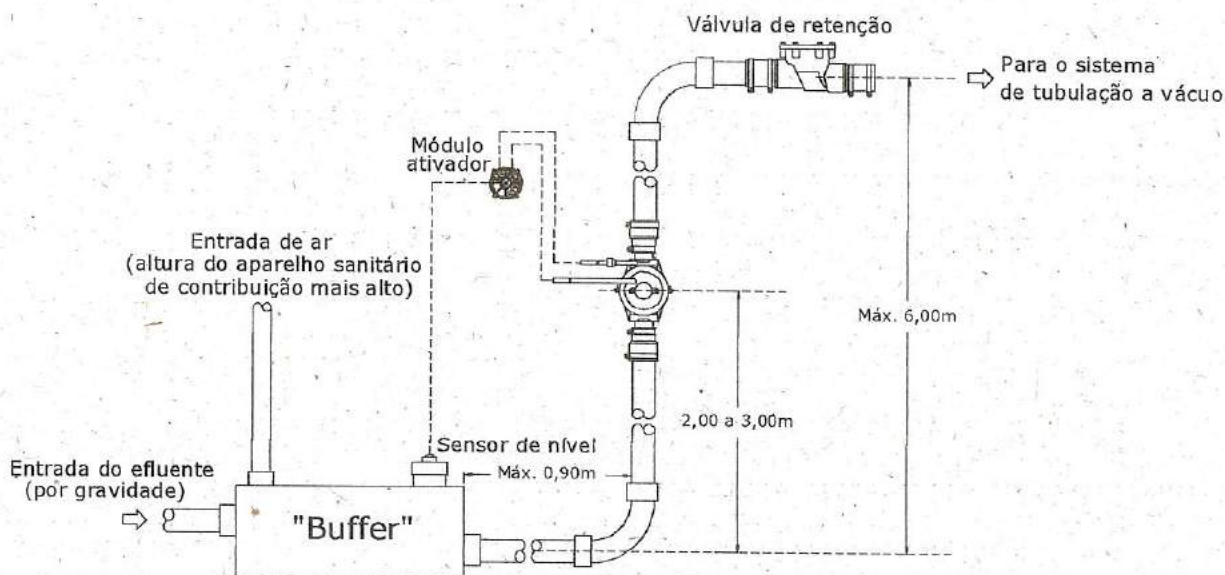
Arranjo com elevação descarga à 1/3 da elevação, retenção no topo.
